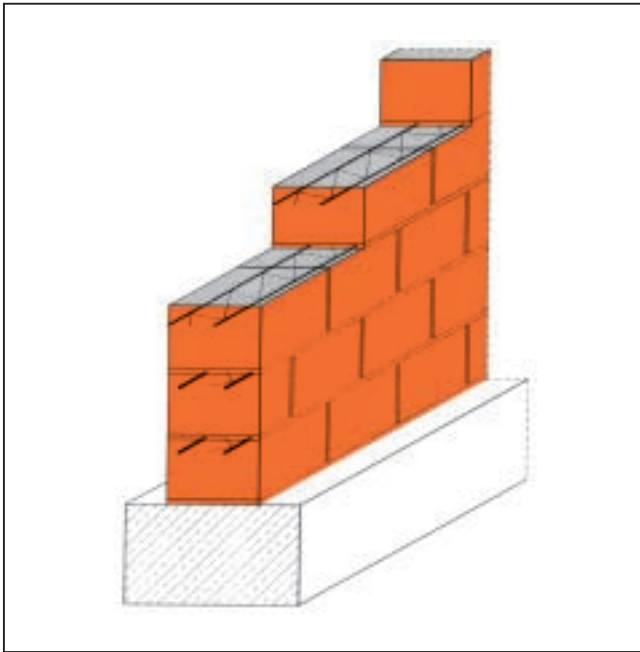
Bewehrtes Kellermauerwerk aus großformatigen Wärmedämmziegeln mit „Murfor-Gitter“-Bewehrung
